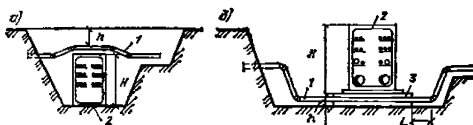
Переходы трубопровода над (а) и под (б) тоннелем:
